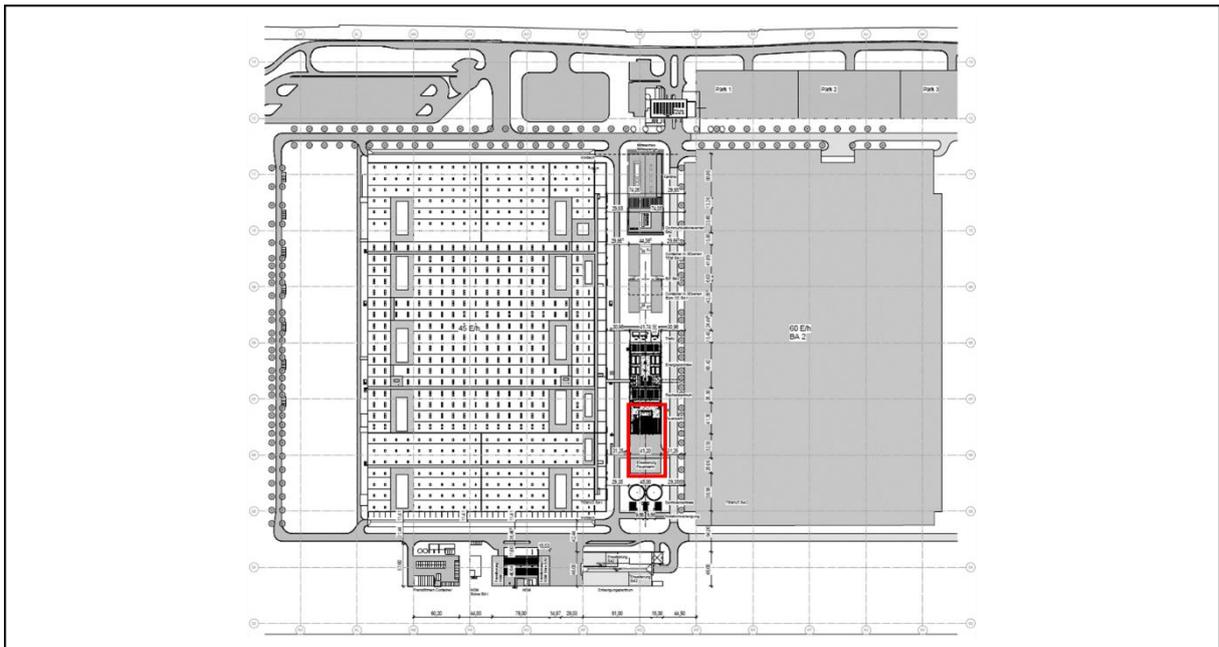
Feuerwehr Lageplan, Draufsicht.
